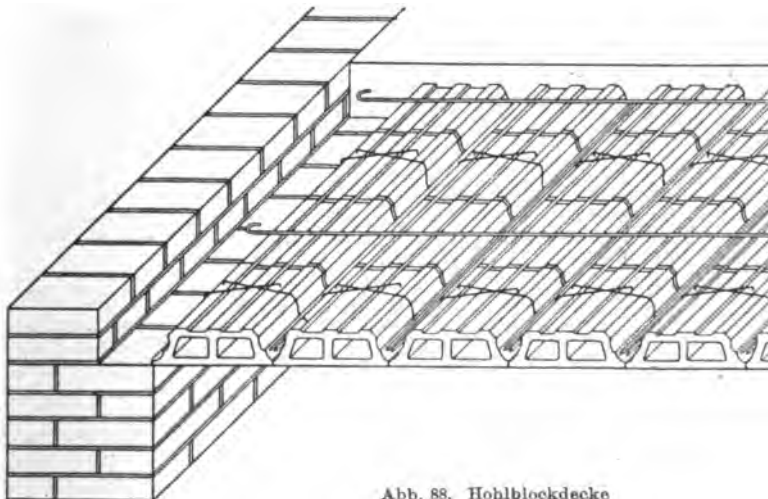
Hohlblockdecke der Fa. Eisenbetonbau Walter Rude.
